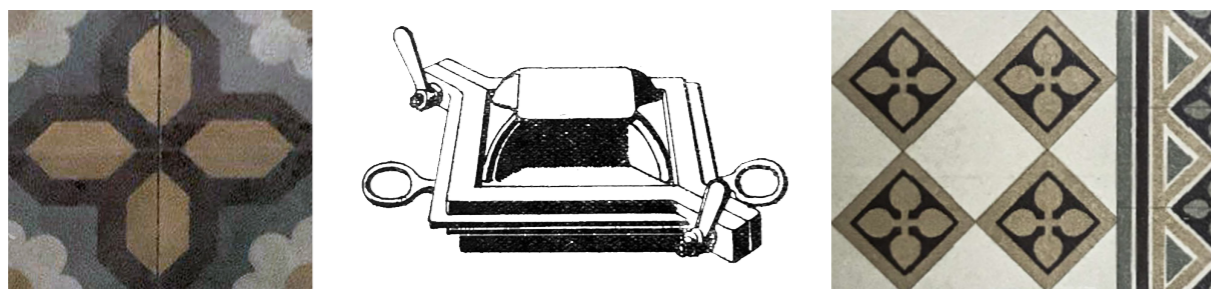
A sinistra, particolare “cementine” Palazzo Brasini. Al centro “presse idrauliche” per la realizzazione delle cementine (fonte Album Pavimenti, Ditta Ing. S. Ghilardi). A destra: foto Album Pavimenti, Ditta Ing. S. Ghilardi, Edizione 1924, Milano.
